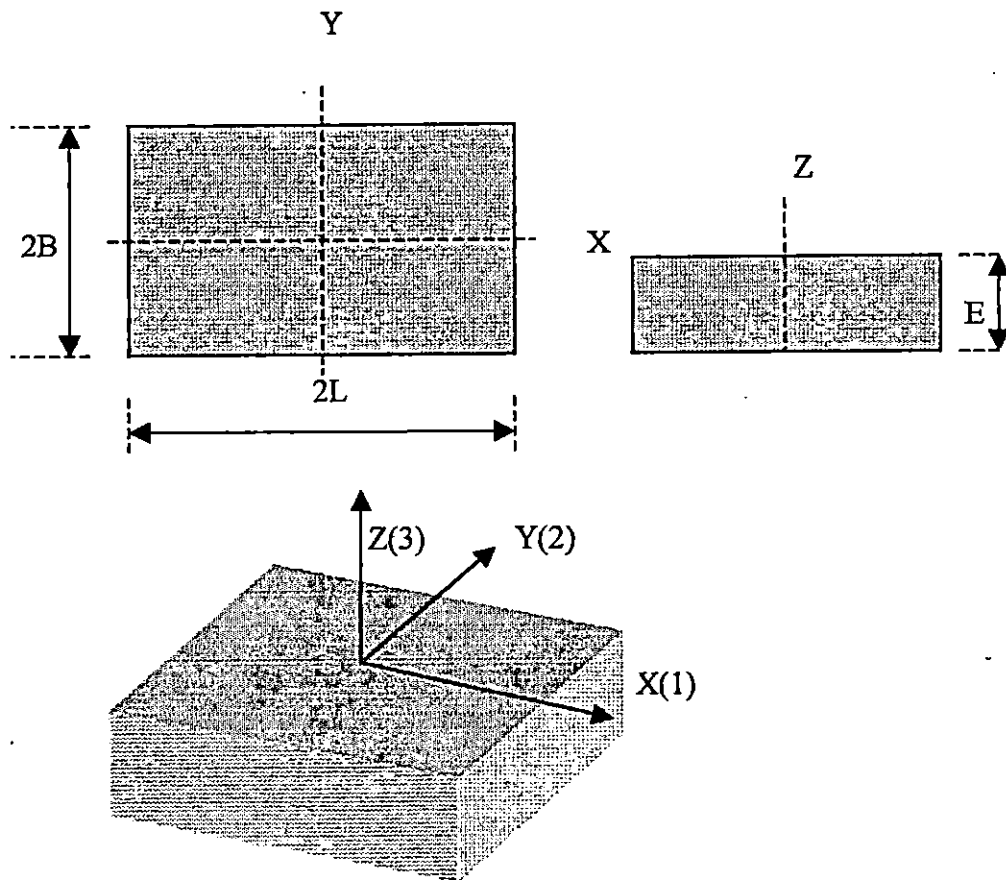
PARAMETROS GEOMETRICOS Y SISTEMA DE COORDENADAS PARA UNA ZAPATA RECTANGULAR.
